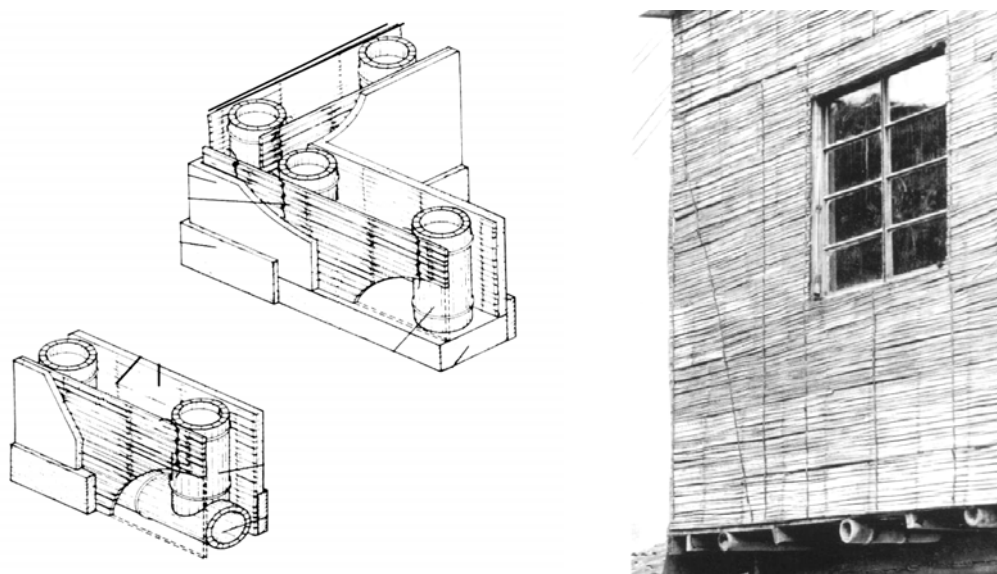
Detalhes construtivos dos painéis do tipo bahareque (LÓPEZ, 2003, p.240).
